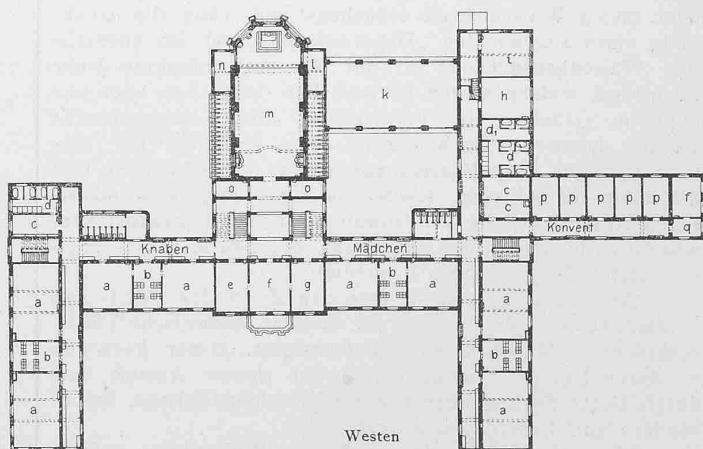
Grundriss vom I. Obergeschoß. — Masstab 1:1000.
